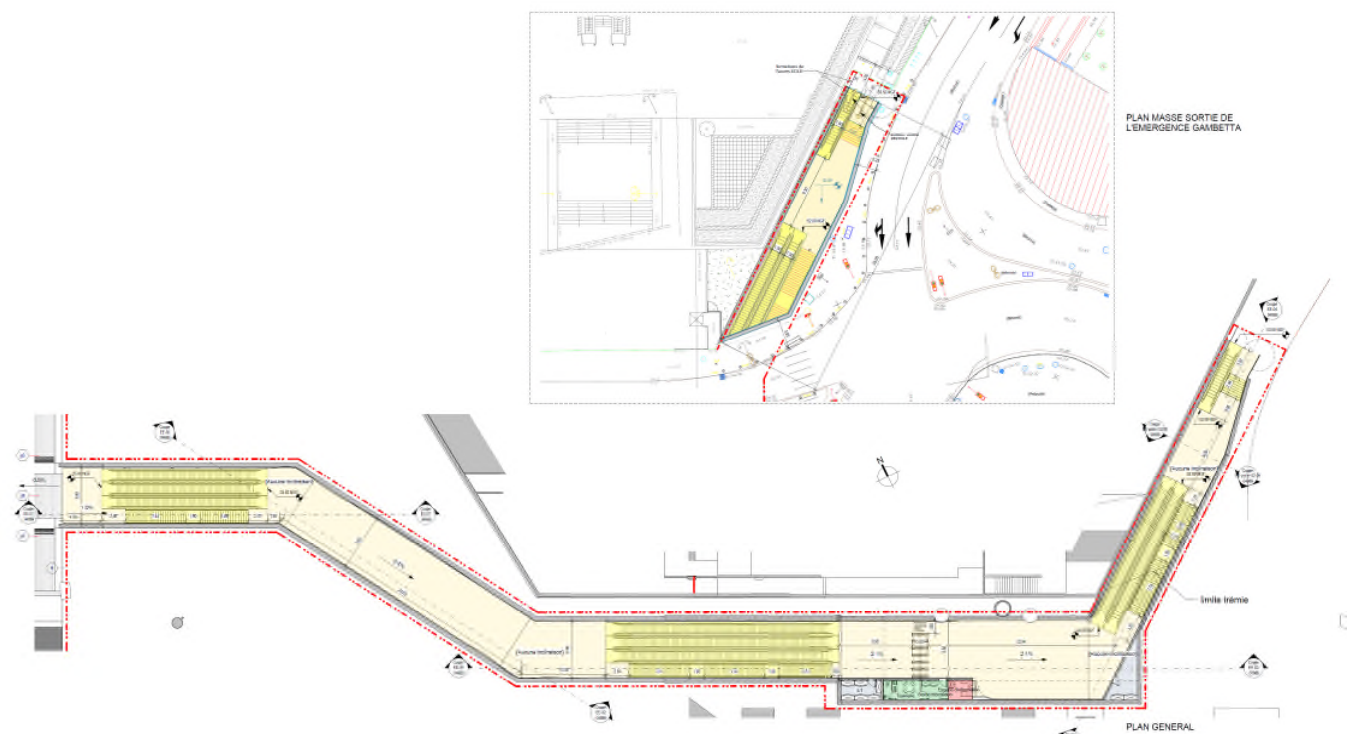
Vue en plan de l'émergence Gambetta (Source : SED)
